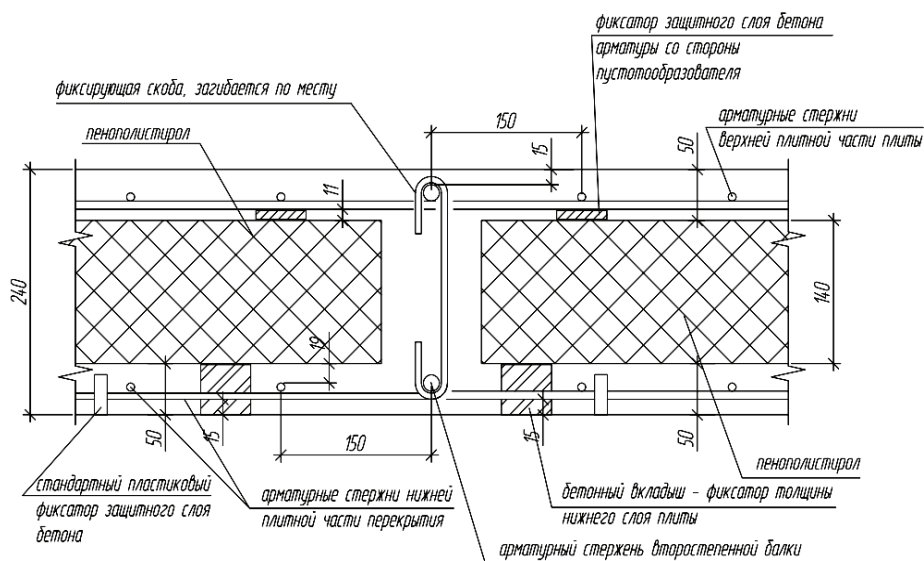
Конструктивная схема монолитного плоского перекрытия с призматическими вкладышами.
